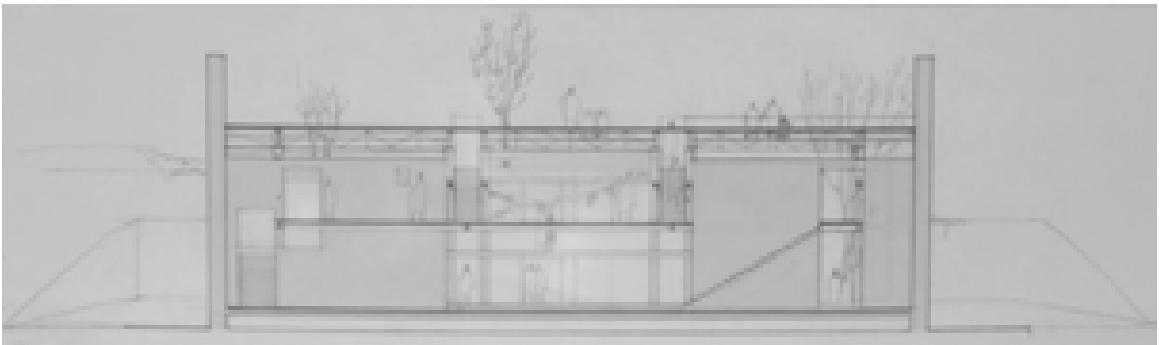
Sezione longitudinale EF allegata al plastico del progetto definitivo (AABS-919)
